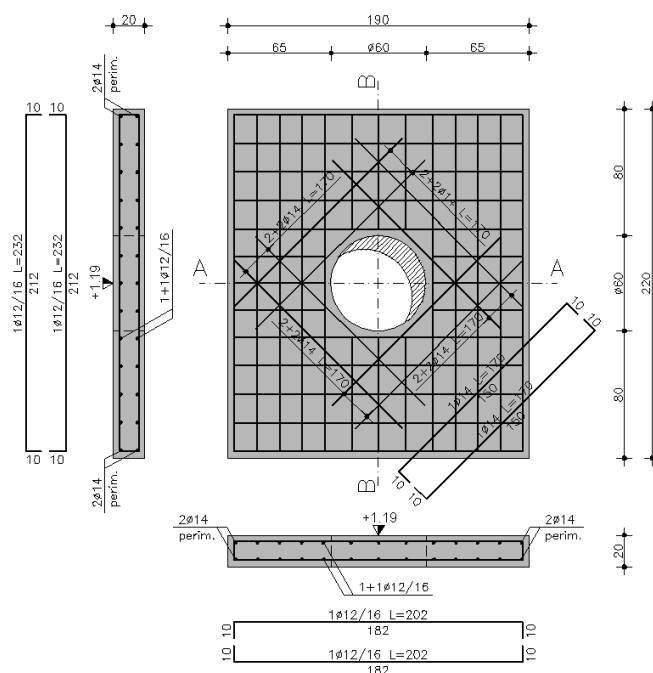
Pozzetto n. 6 - Pianta coperto appoggiato
